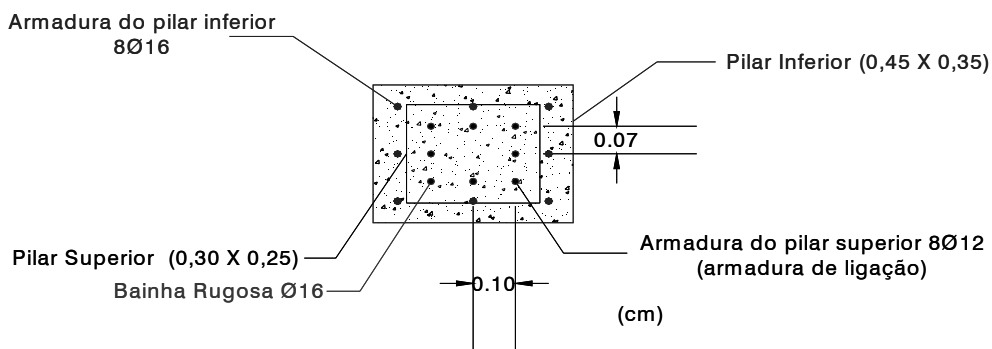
Esquema da sobreposição dos pilares no piso 3 e consequentes armaduras de ligação
